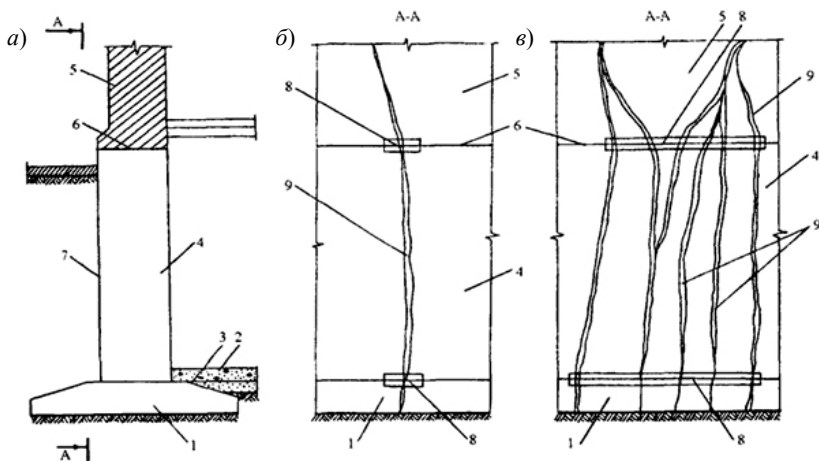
Характер повреждения гидроизоляции фундаментов стен подвала:
